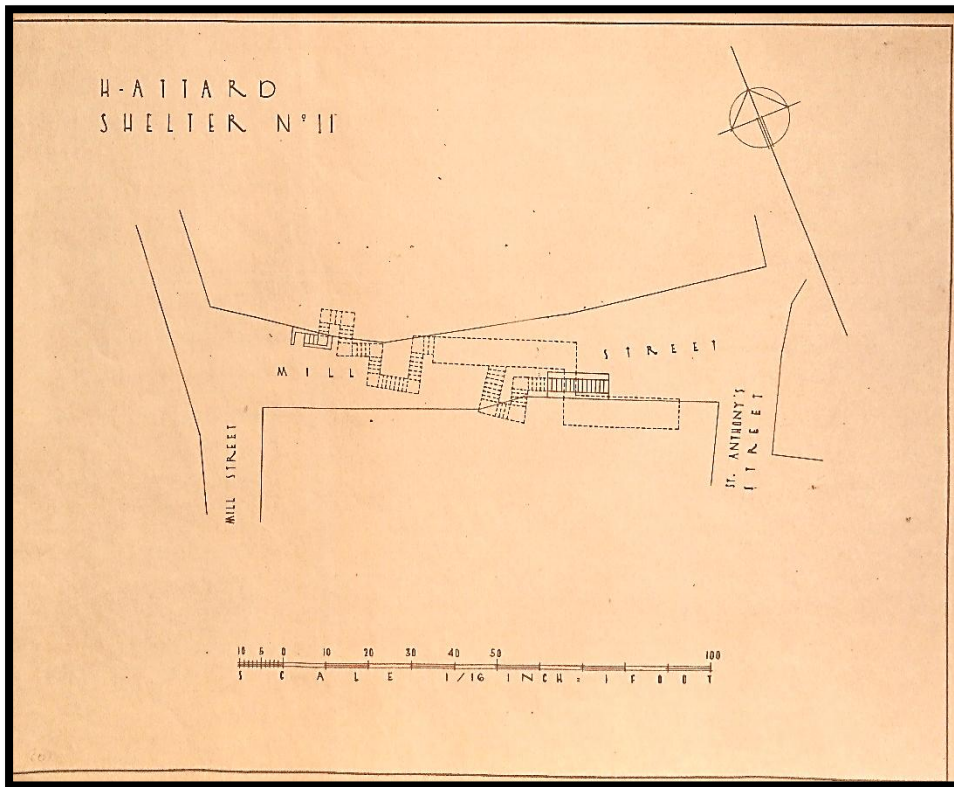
Planta do Abrigo nº11 "Mill Street – St. Anthony's Street."
